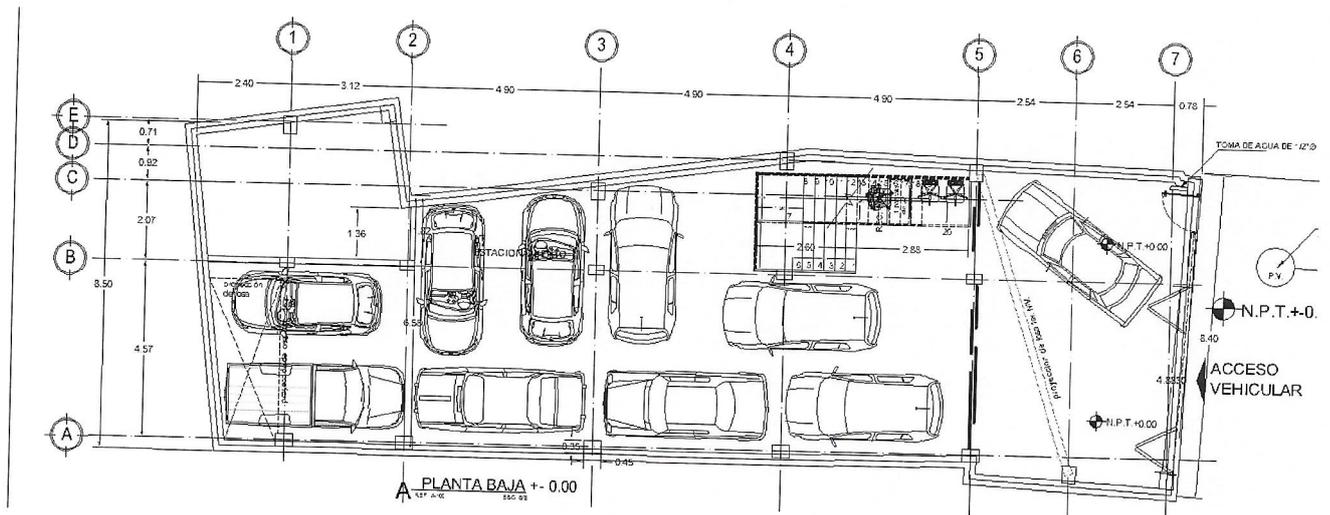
Planta de Estacionamiento de proyecto de oficinas
